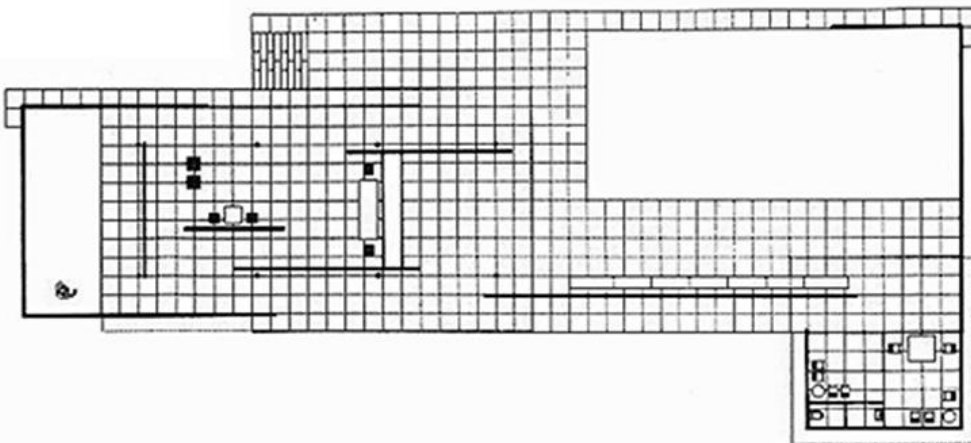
Grundriss vom Parterre [26]
